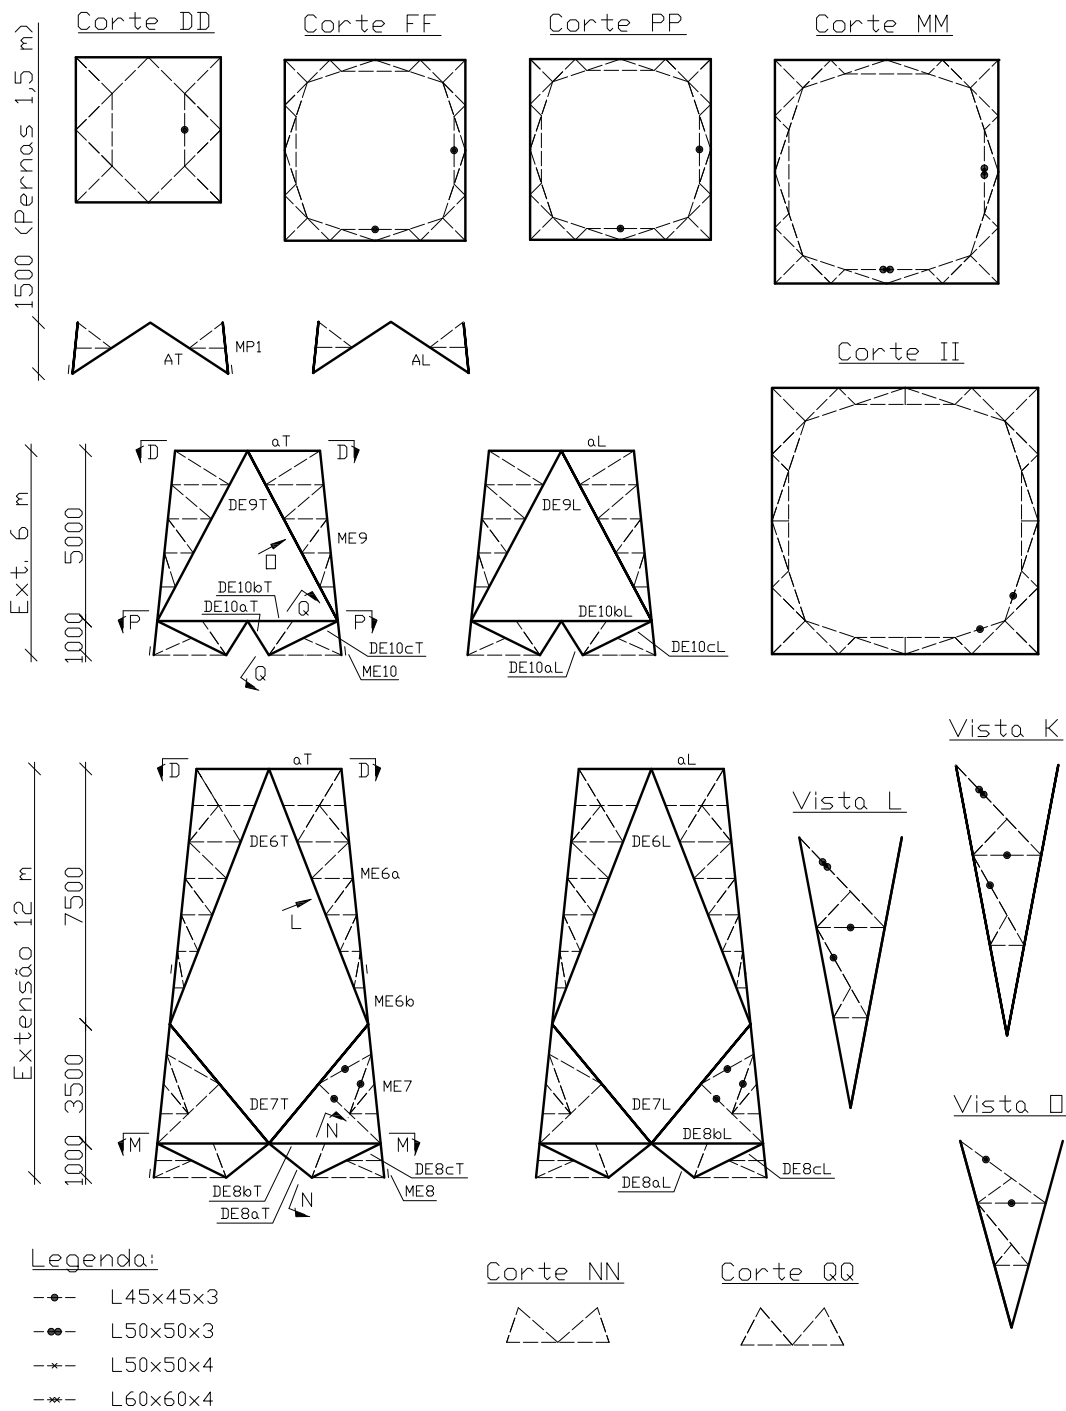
Demais elementos do detalhamento da família de oito torres, em mm
